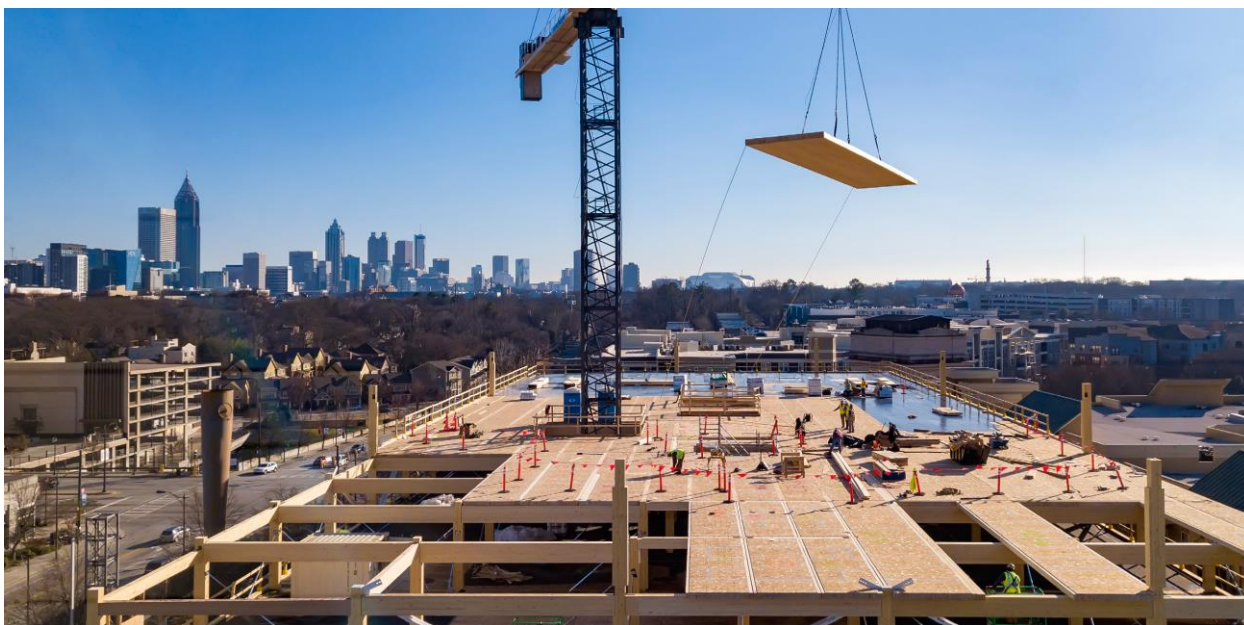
Монтаж деревоплит в перекрытии.
